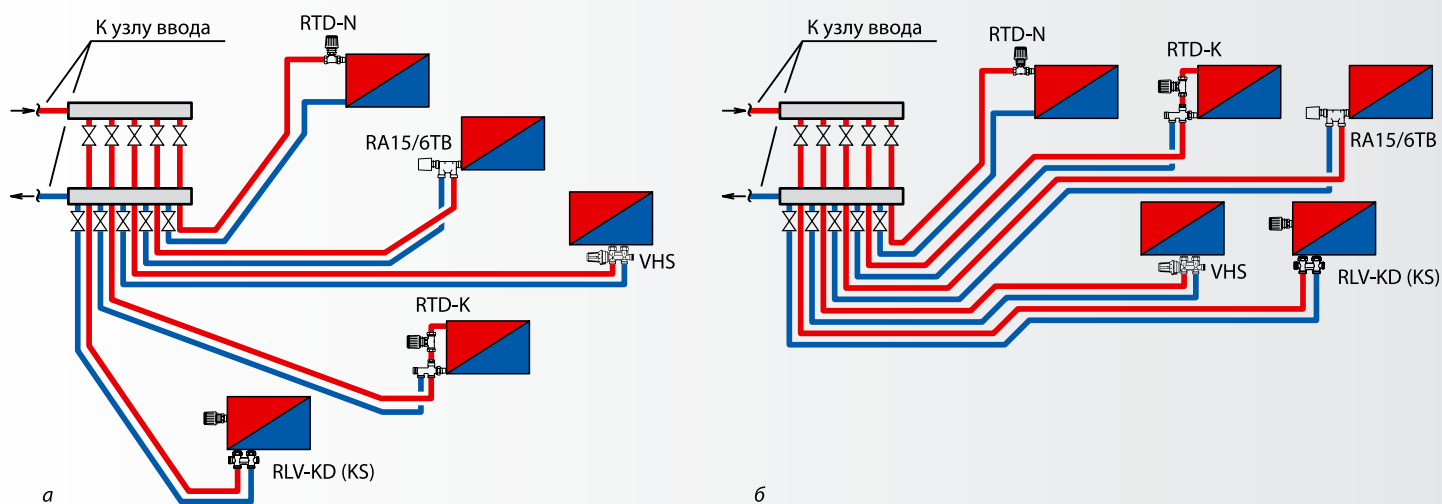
Двухтрубная лучевая разводка квартирных трубопроводов: а — с произвольной трассировкой; б — с пристенной трассировкой.
